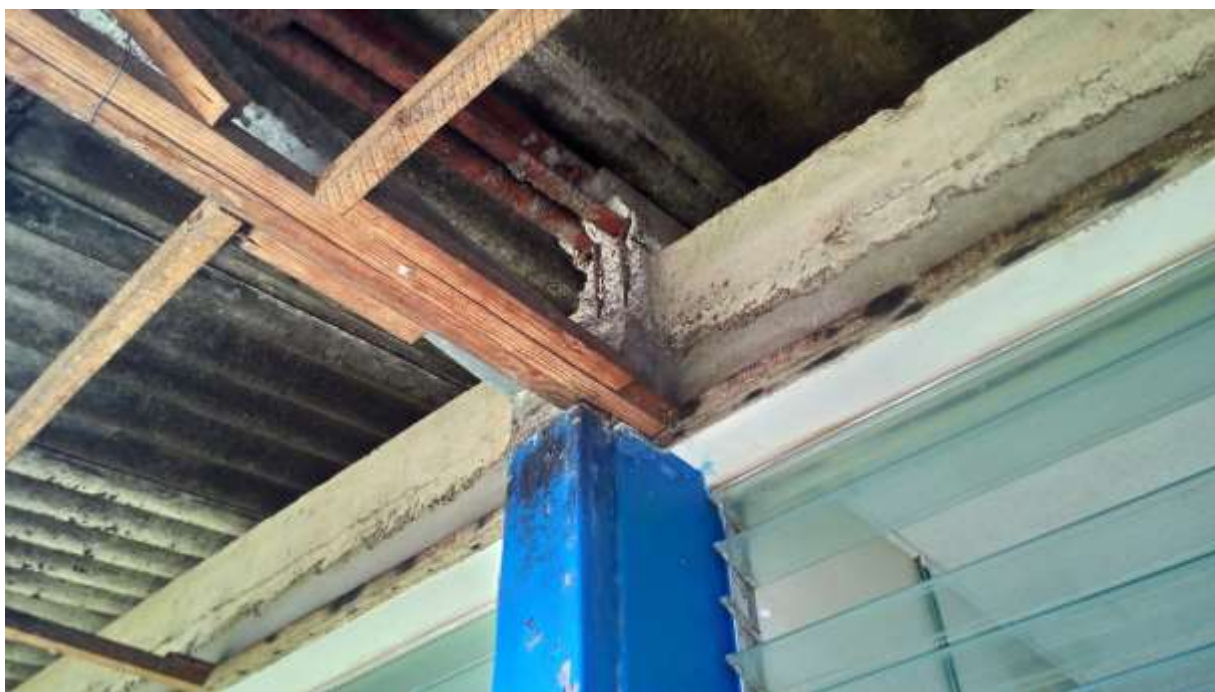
Acero de refuerzo expuesto por columna con efecto de corrosión.
